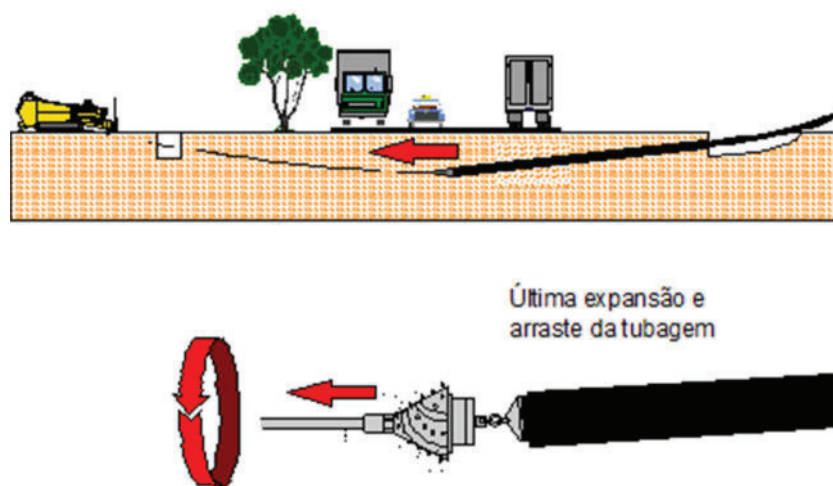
Fase de alargamento do furo, após a execução do duro piloto
